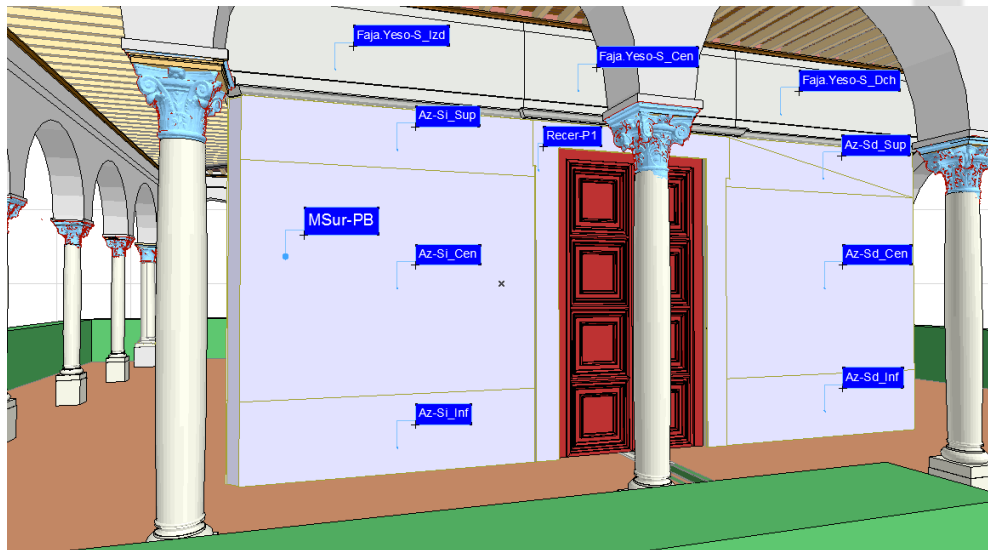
Documento 3D de ArchiCAD con etiquetas en los paños de azulejos de la fachada Sur del Cenador.
